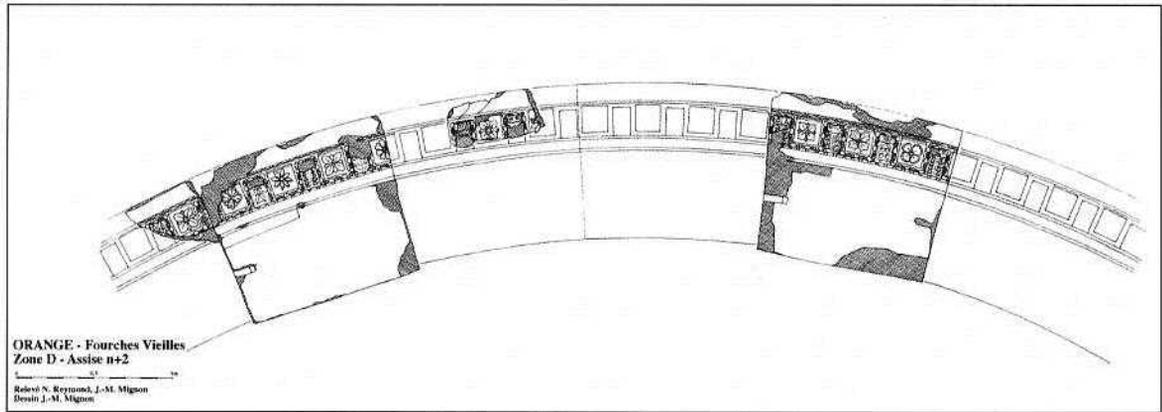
Plan d'assemblage de la corniche du mausolée D.
